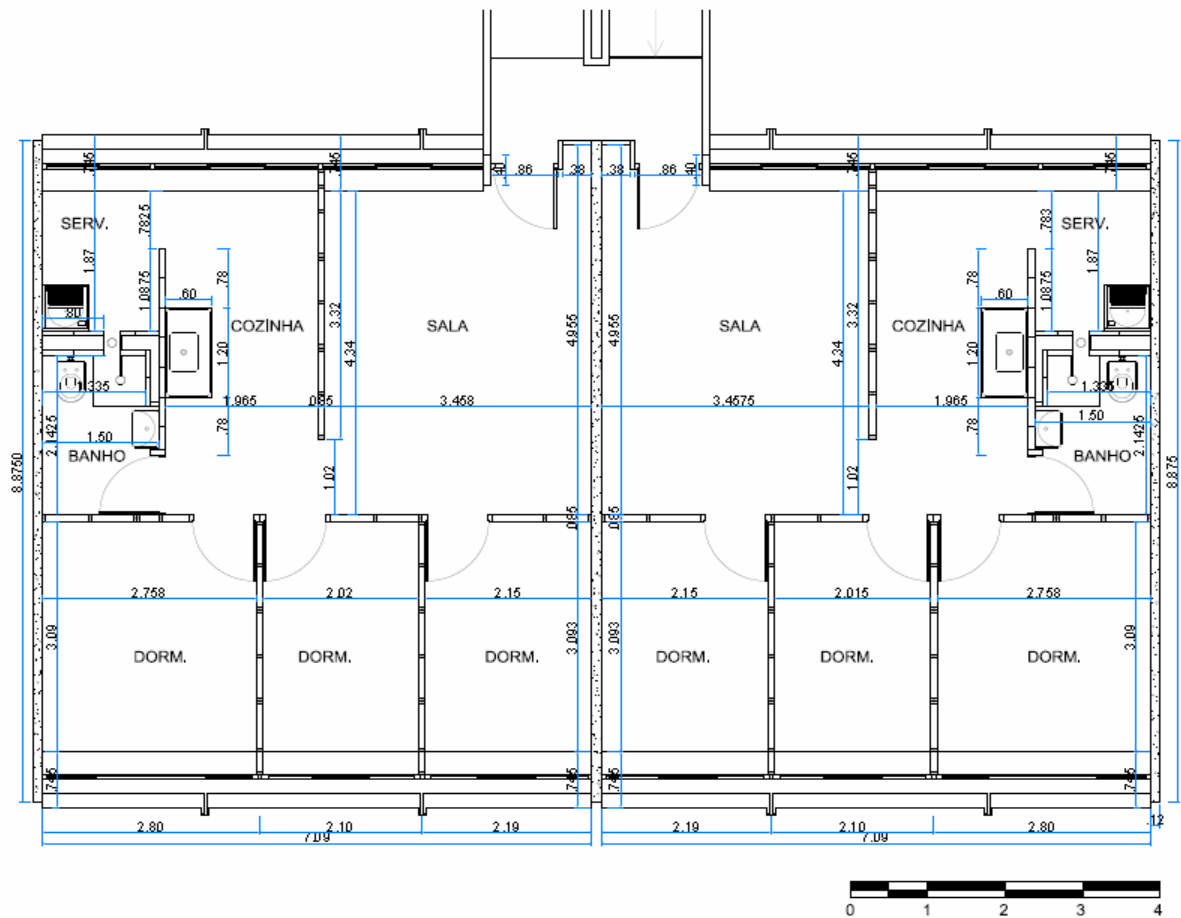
Planta Apartamento Tipo - CECAP Jundiaí/SP.
